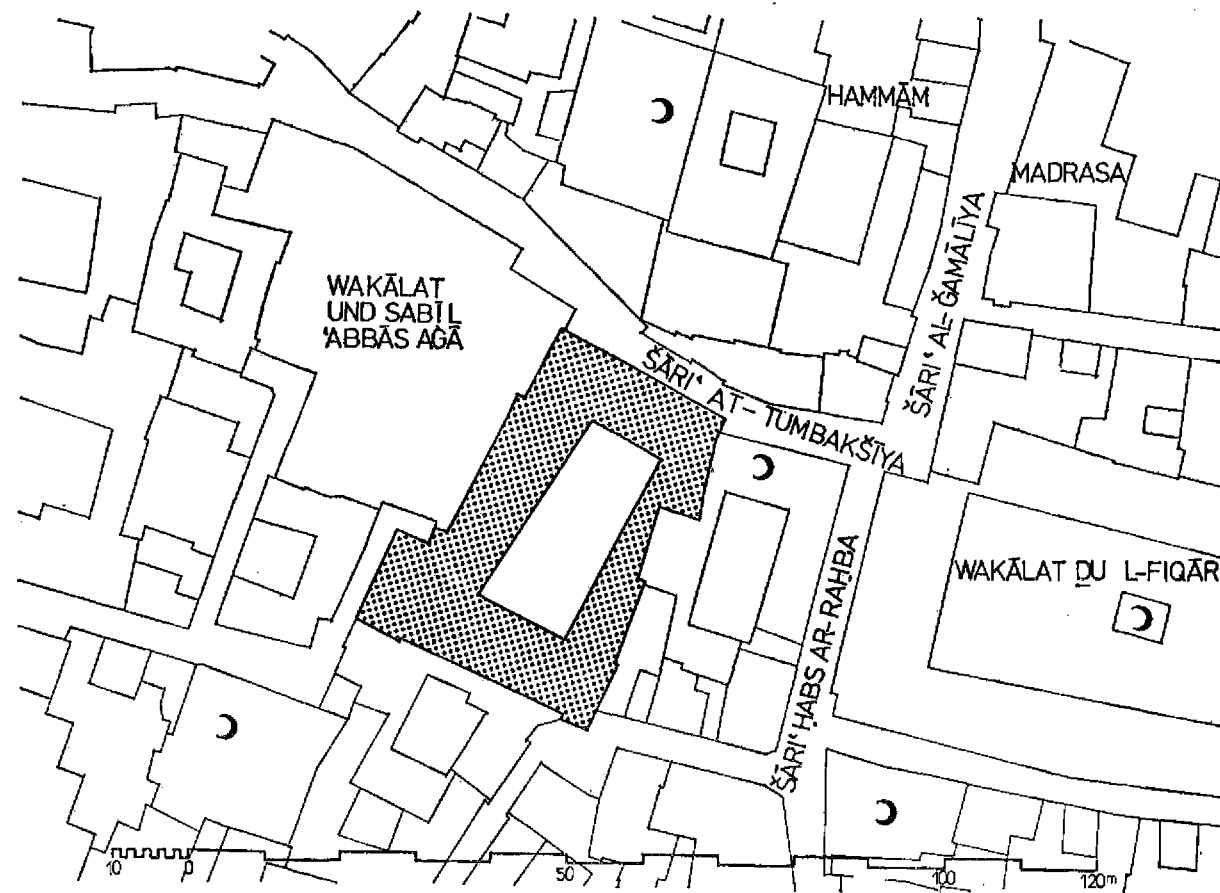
Kairo, Wakalat al-Bazar'a, Lageplan
